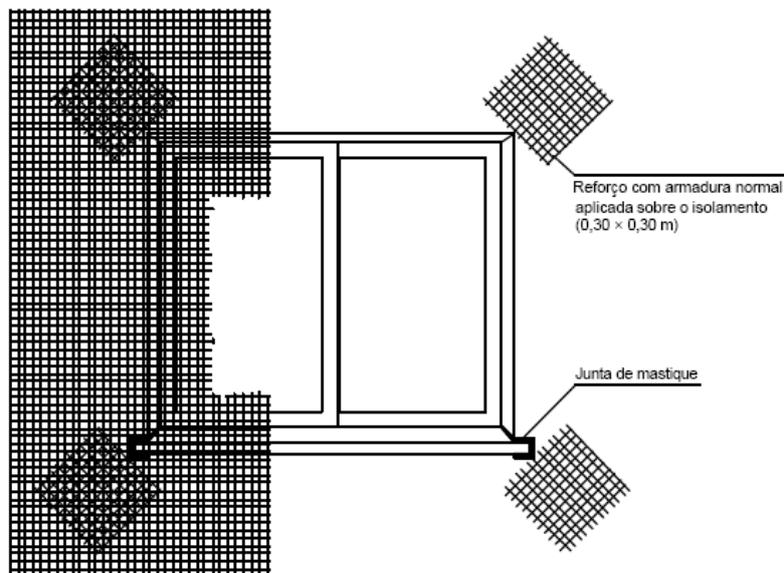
Reforço da armadura no contorno dos vãos da fachada
